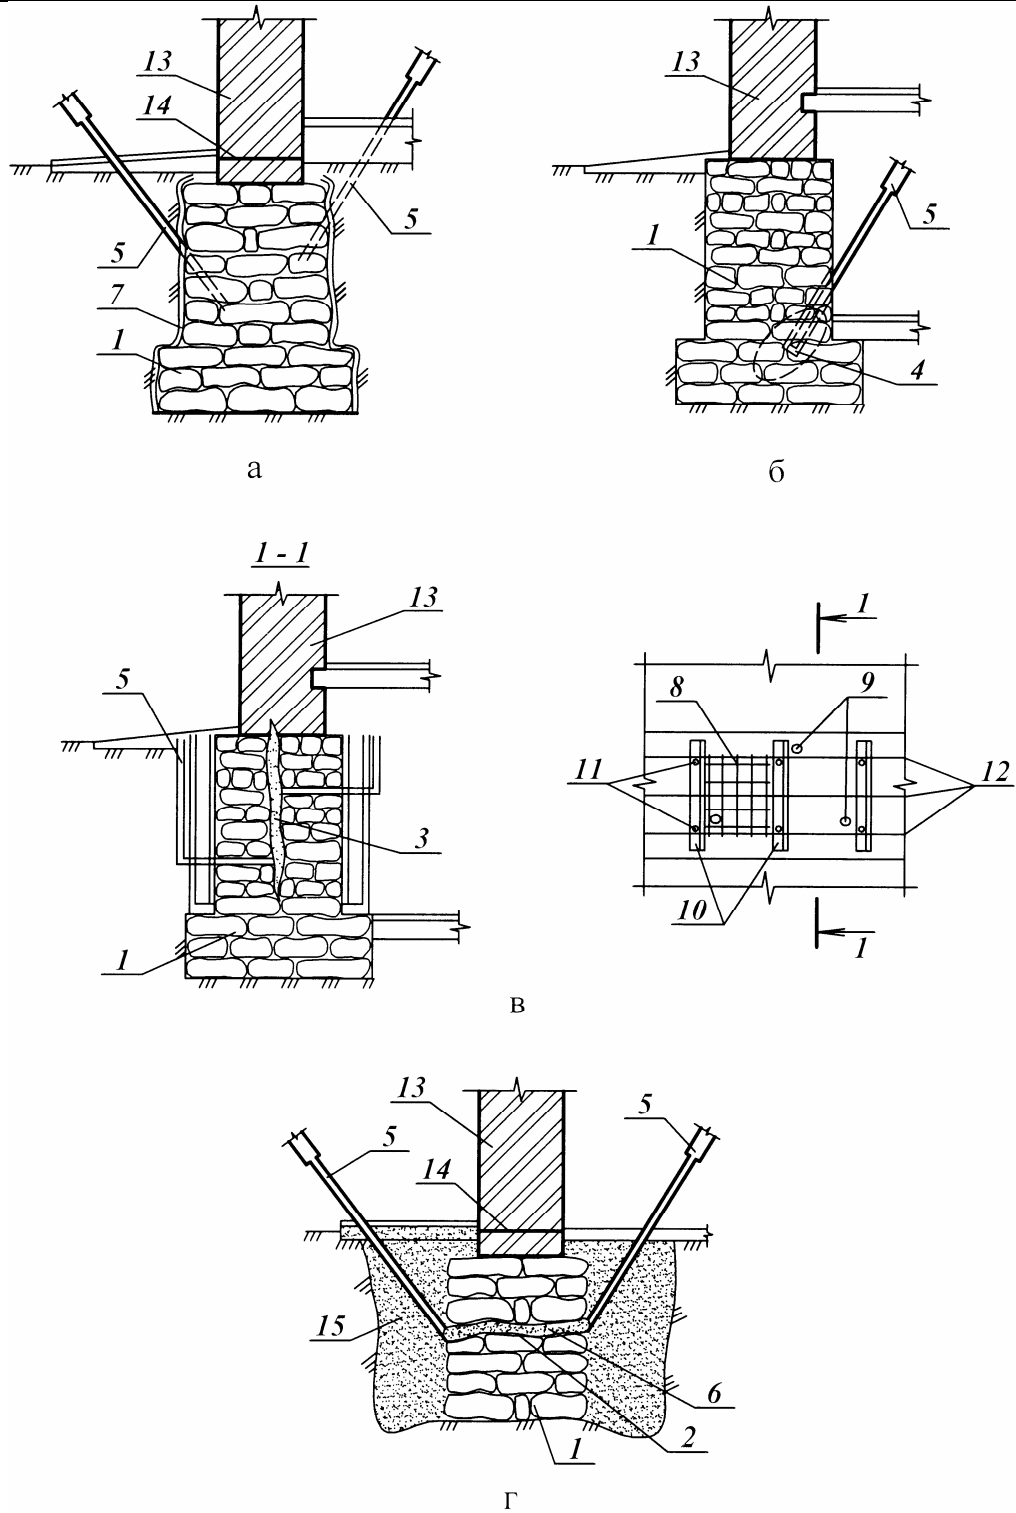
Усиление бутобетонных ленточных фундаментов методом инъектирования:
